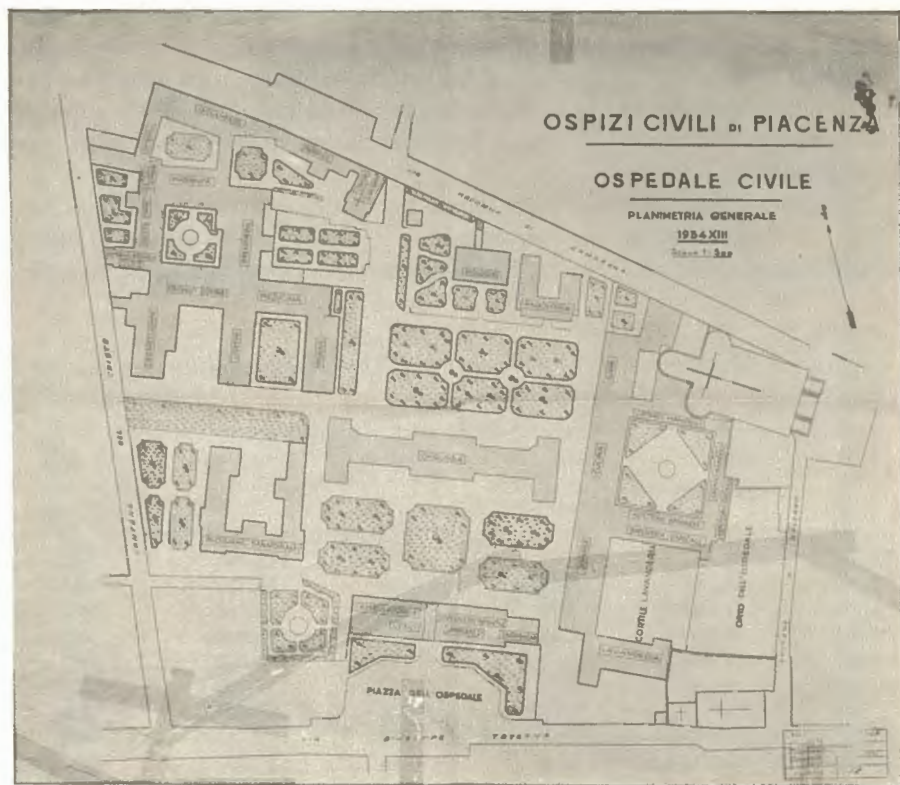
Archivio dell'Ospedale di Piacenza, Planimetria del 1934.
